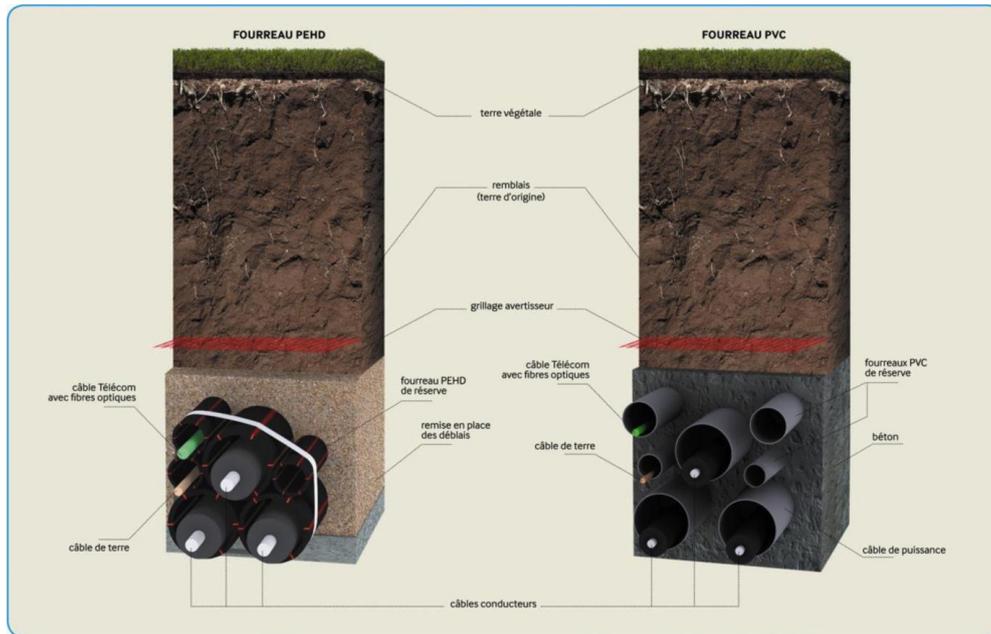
Schéma de pose en fourreau PEHD (© RTE) (gauche) et en fourreaux PVC (© RTE) (droite)
